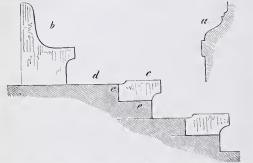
Details vom Theater zu Segeste, Aufn. von Mothes.
